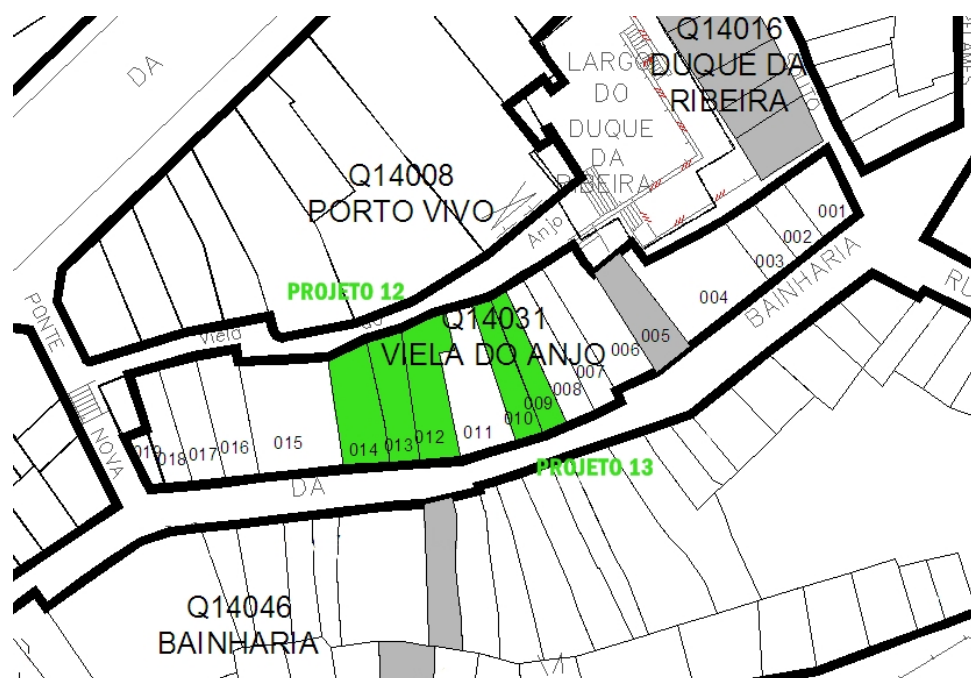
Planta de Localização da Operação G (Fonte: Porto Vivo, SRU)
